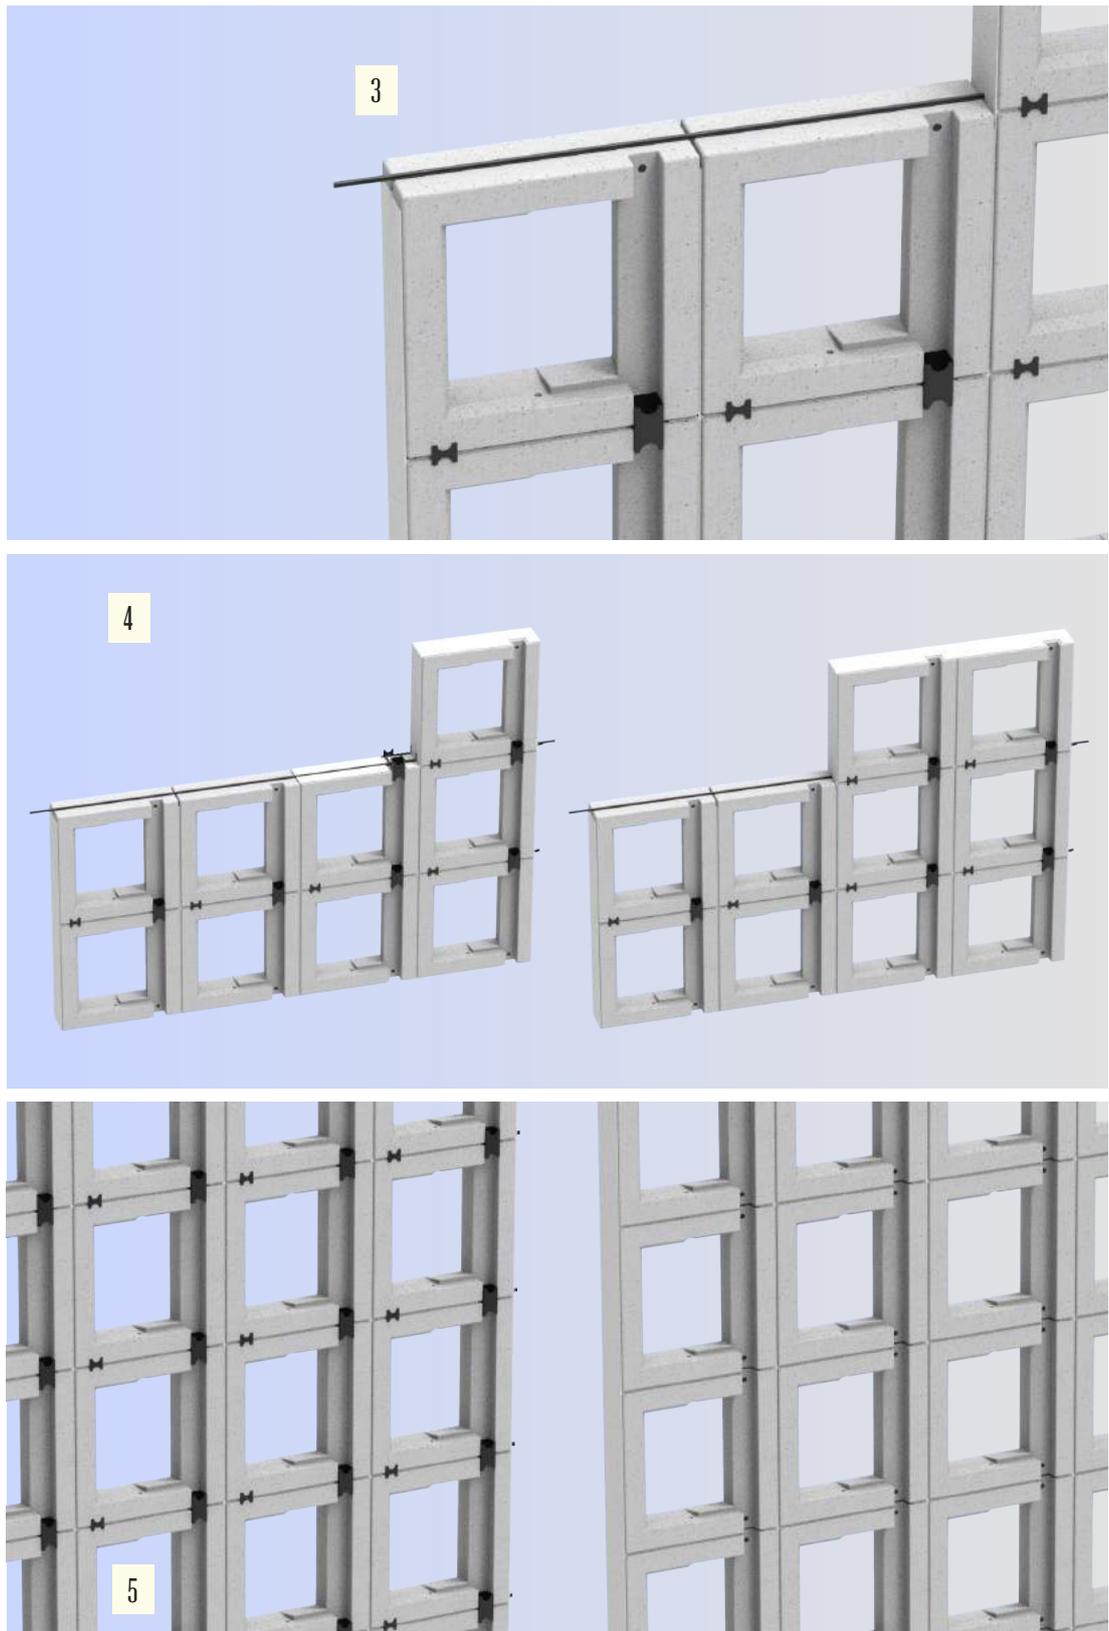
Passo a passo de construção 3-5: A cada duas fileiras na horizontal é necessário inserir um vergalhão para melhor resistência da parede. Em paredes que exigem maior estruturação, podem ser colocados vergalhões na vertical a cada duas colunas. Ao concluir a construção da parede, com a argamassa já seca, as partes aparentes dos espaçadores podem ser destacadas. Um acabamento com argamassa pode ser feito para cobrir as imperfeições. Fonte: Elaboração própria.
